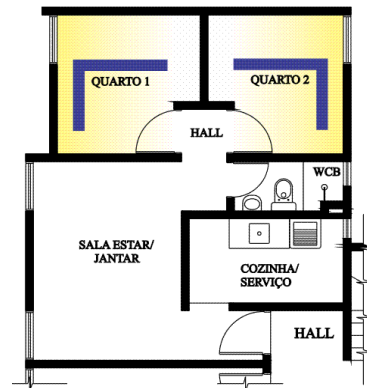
Planta Baixa Pav. Tipo do Residencial Germano Santos (sem escala)
